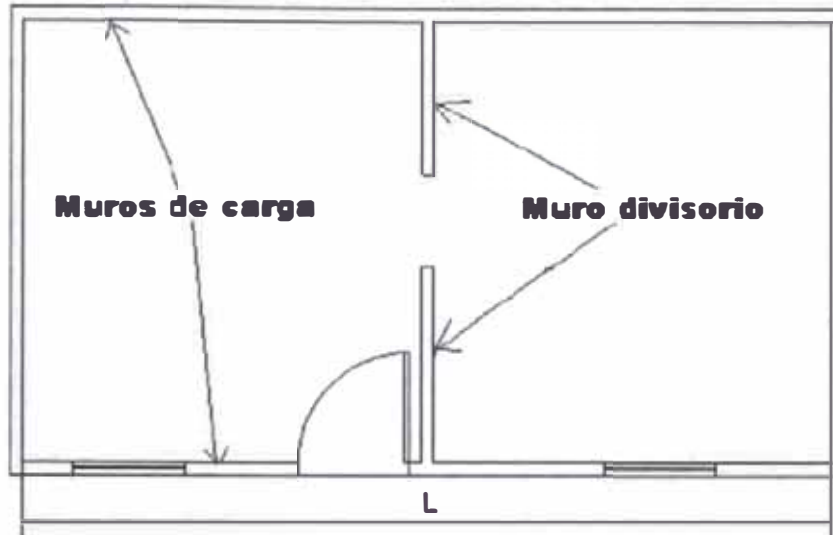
Configuración de los muros en planta de la estructura y su respectiva separación (L).
